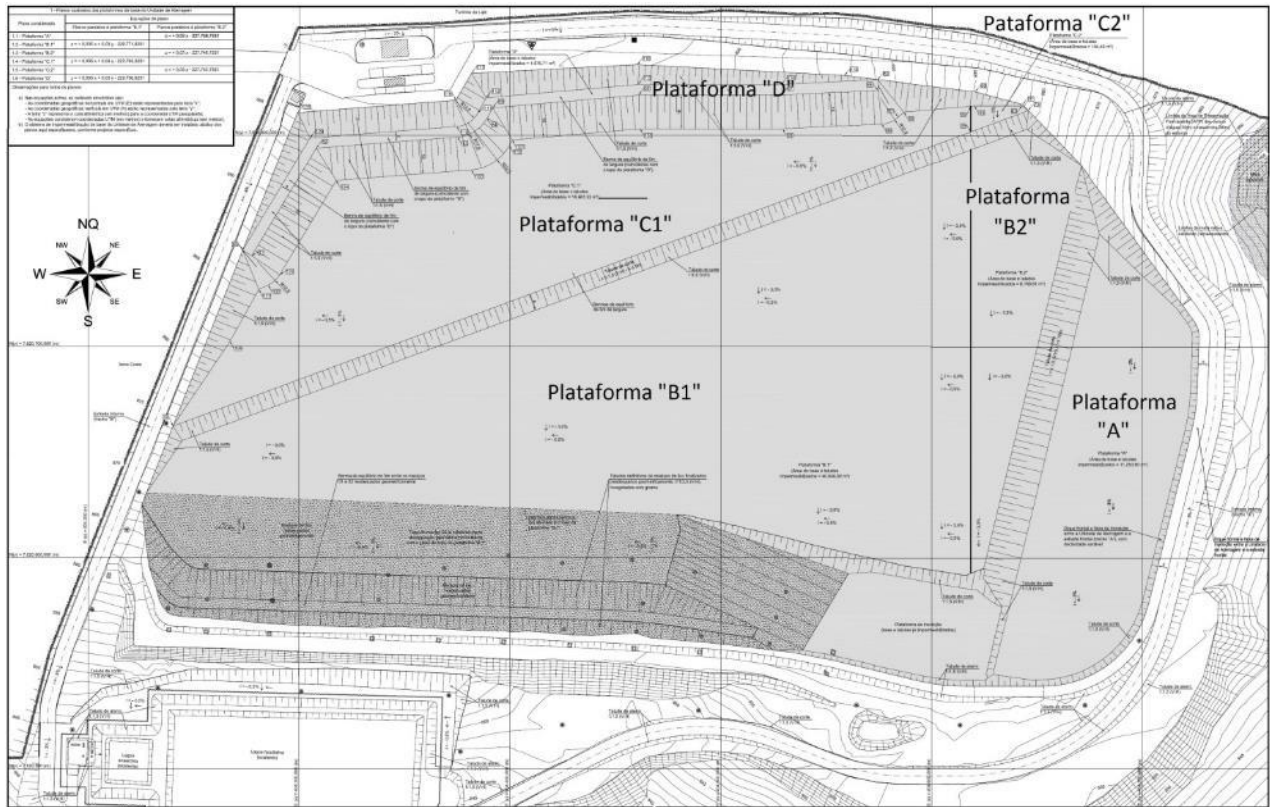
Planta de localização das plataformas A, B1, B2, C1, C2 e D.
